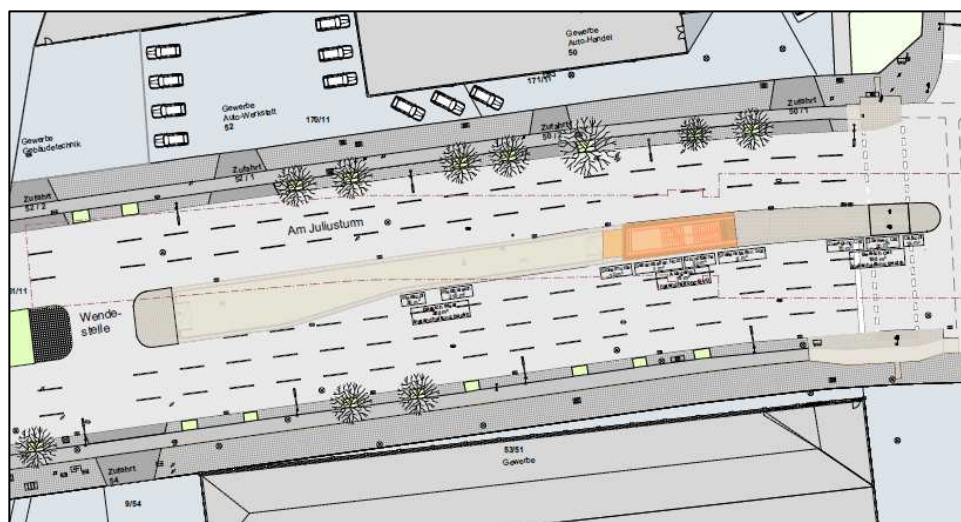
Ausschnitt Plan Zi\_PG 4a Instandhaltung und Sacheigentum
